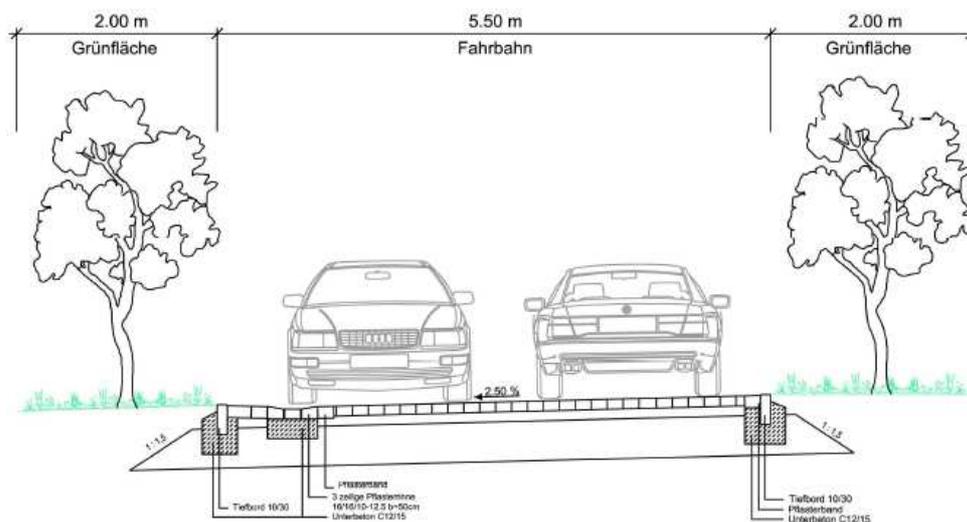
Straßenquerschnitt Planstraßen C-G, L, N
